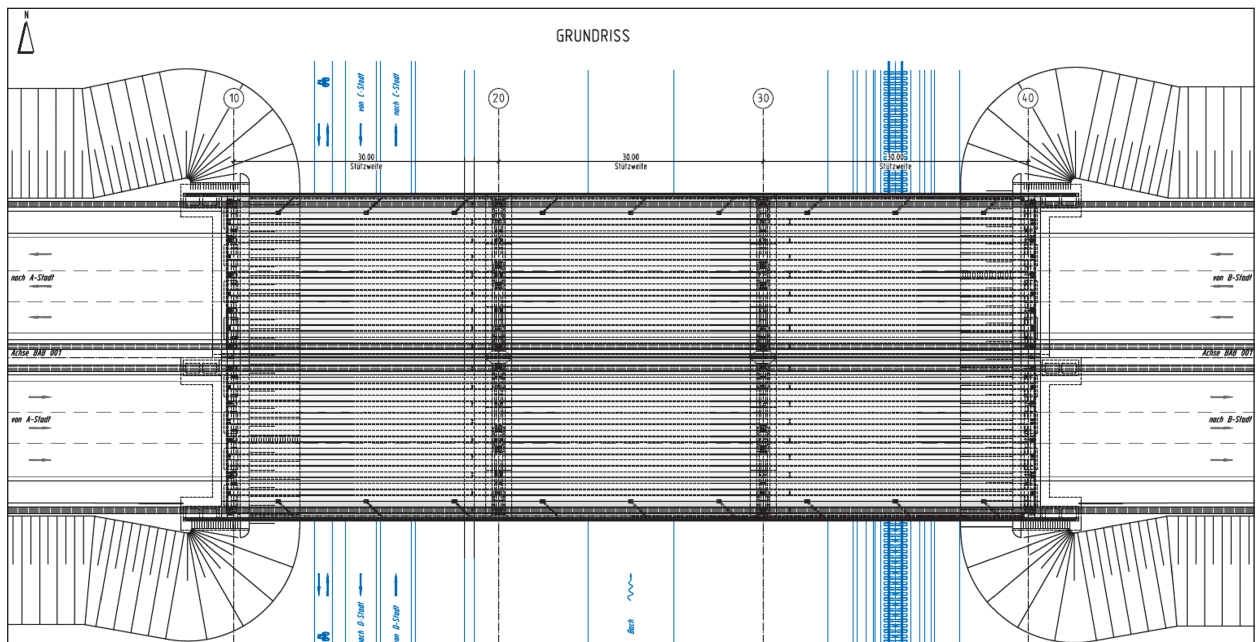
Grundriss Bauwerk 4 Dreifeldbauwerk
